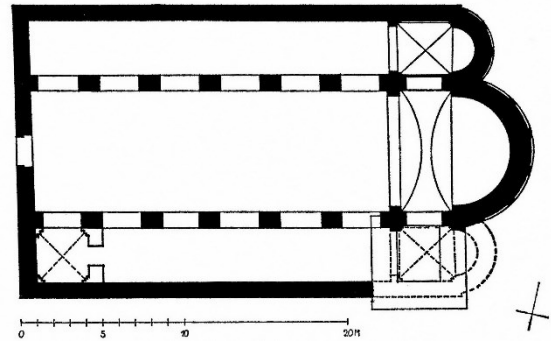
Grundriss der Stiftskirche Amsoldingen
